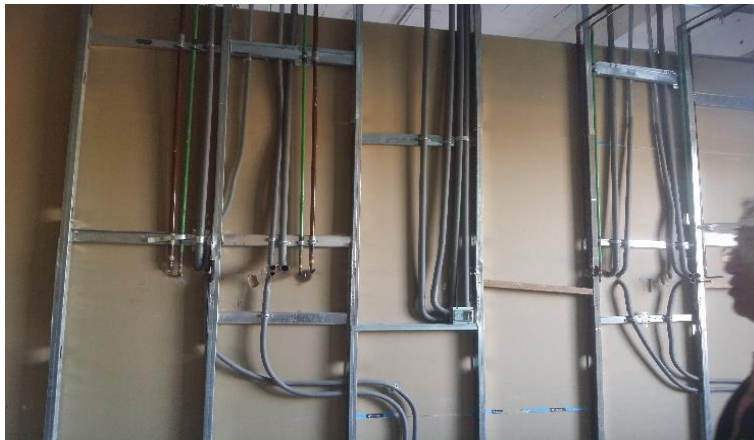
Detalle de los tipos de tabiquería a usar.
